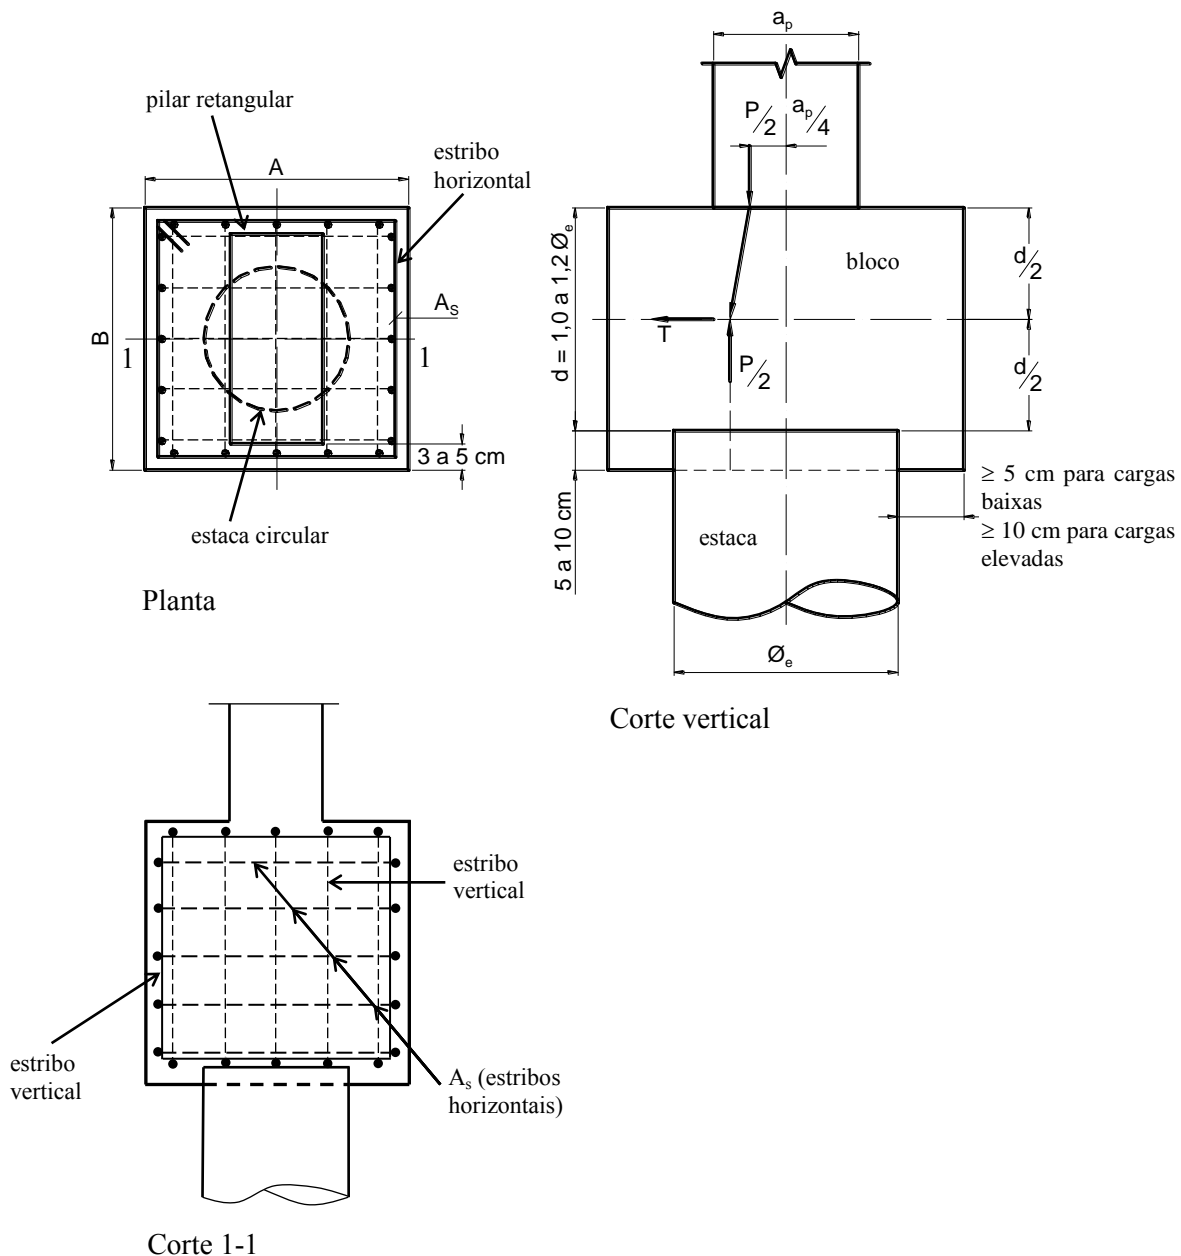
Bloco sobre uma estaca: esquema de forças e detalhes das armaduras.
